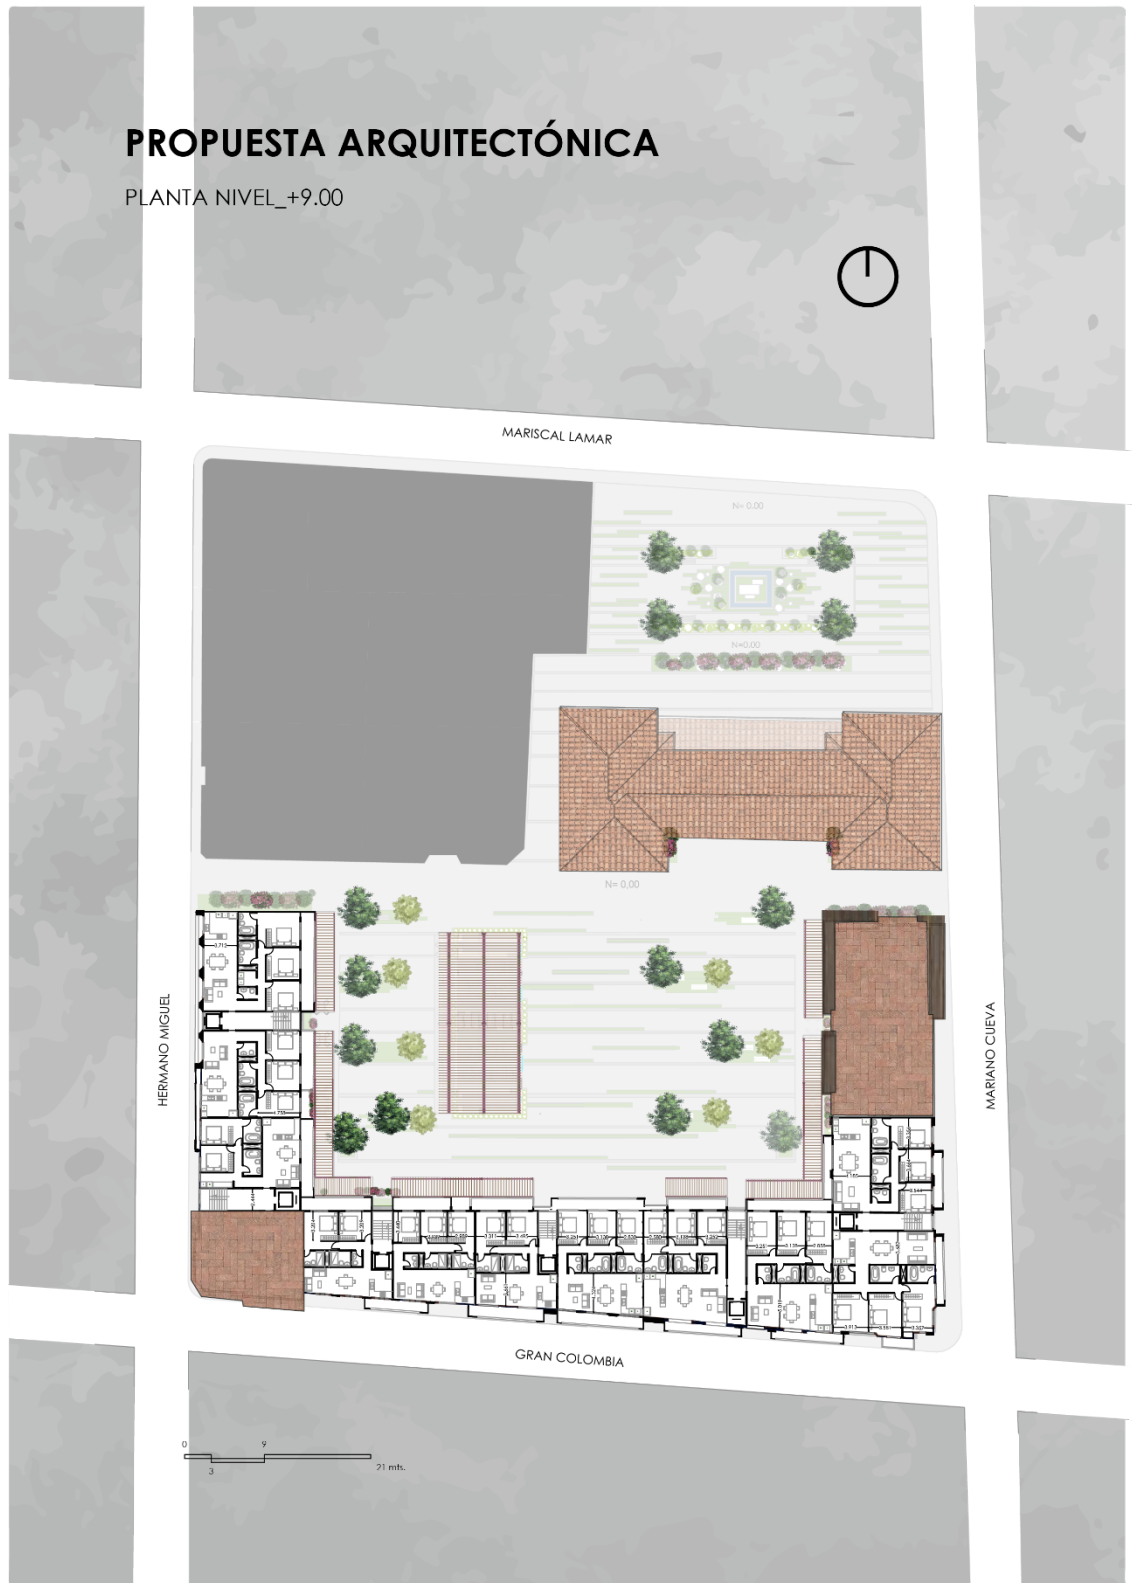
Propuesta Arquitectónica Planta nivel +9.00
